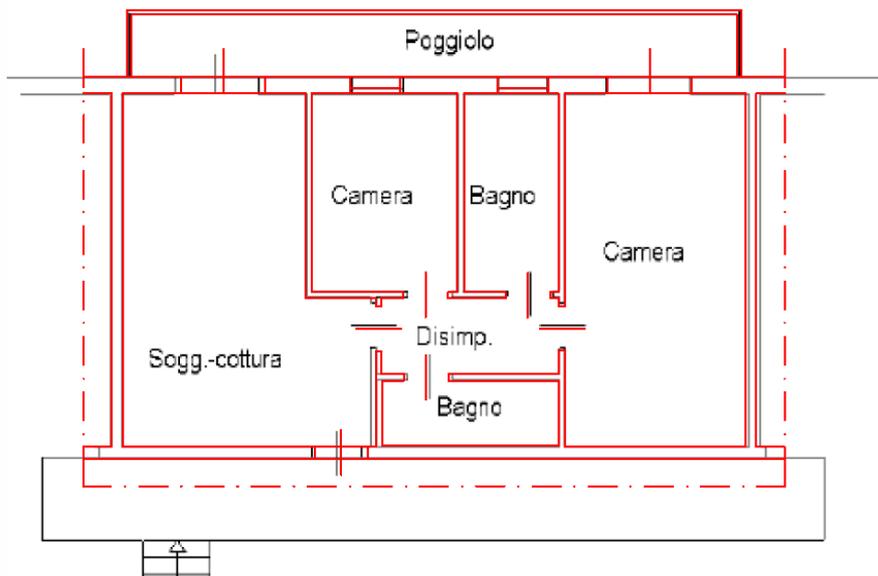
Sovrapposizione planimetria catastale – abitazione.
